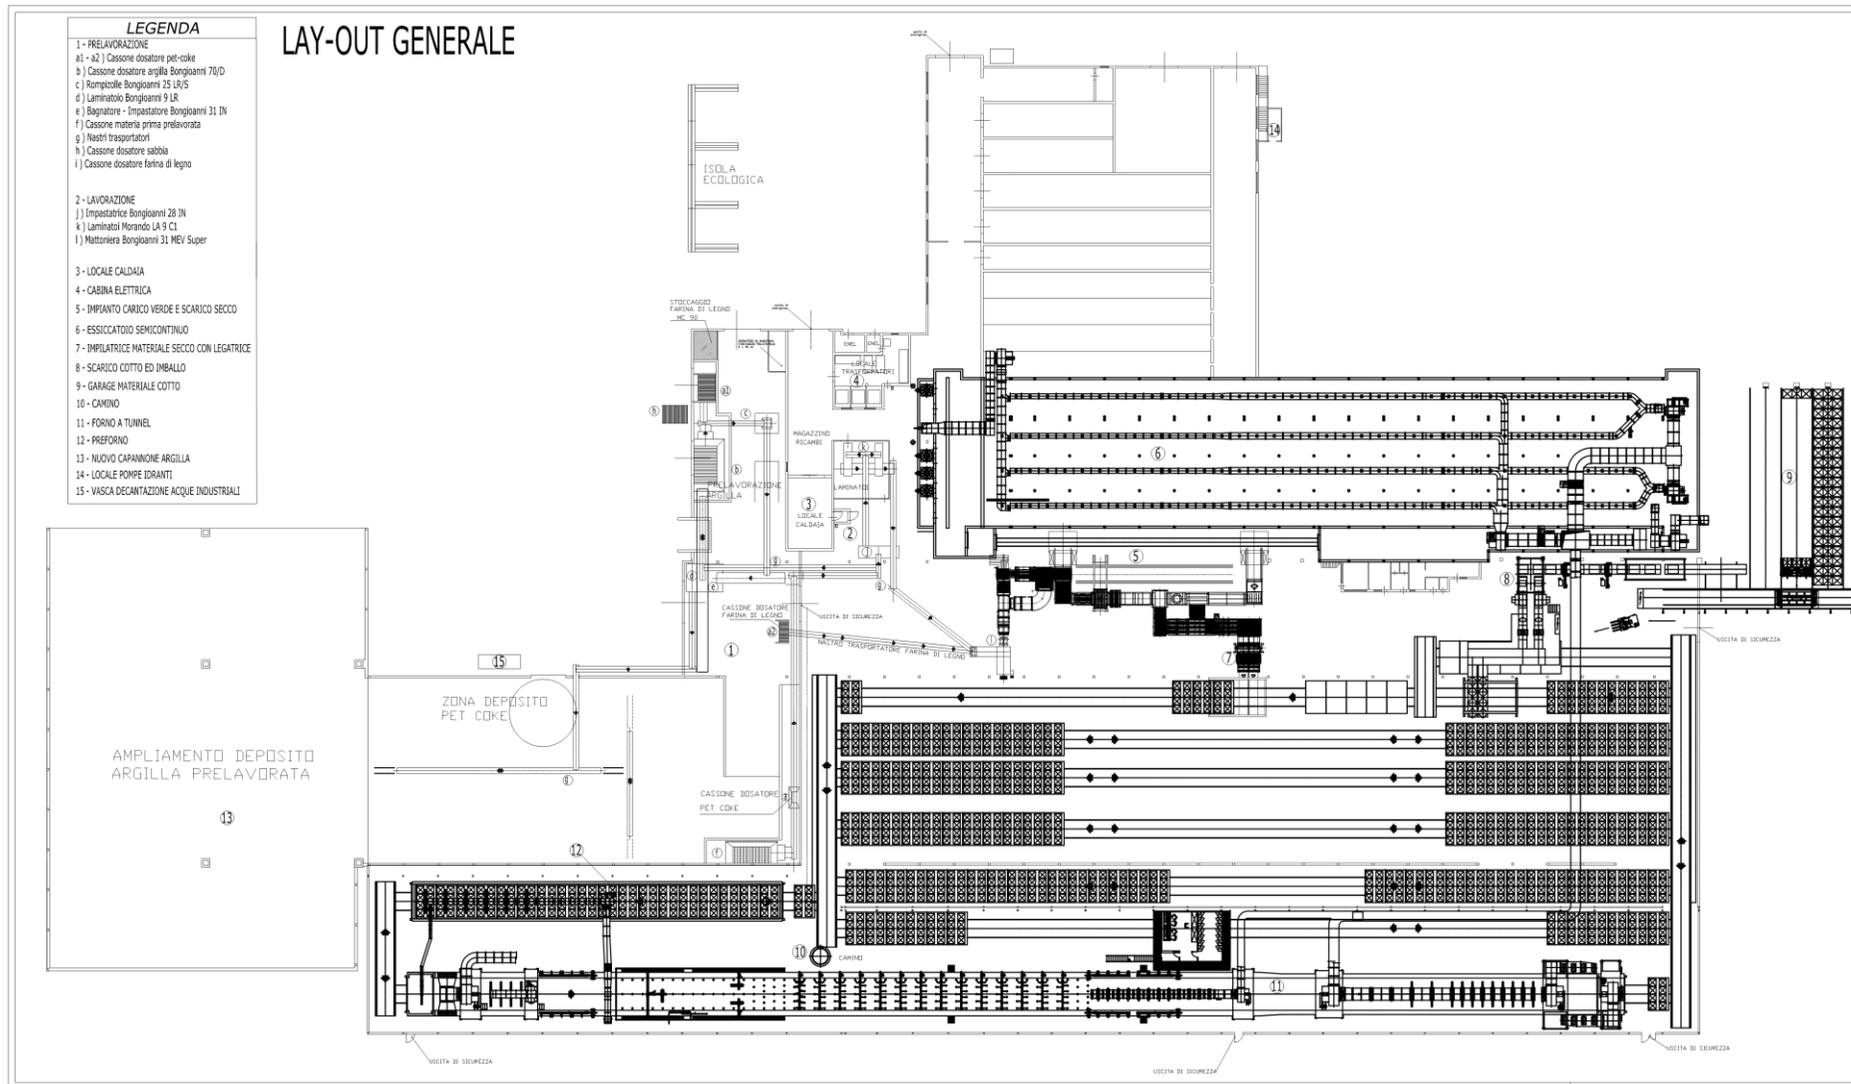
planimetria generale impianto di produzione laterizi S.I.A.I. S.r.l..
